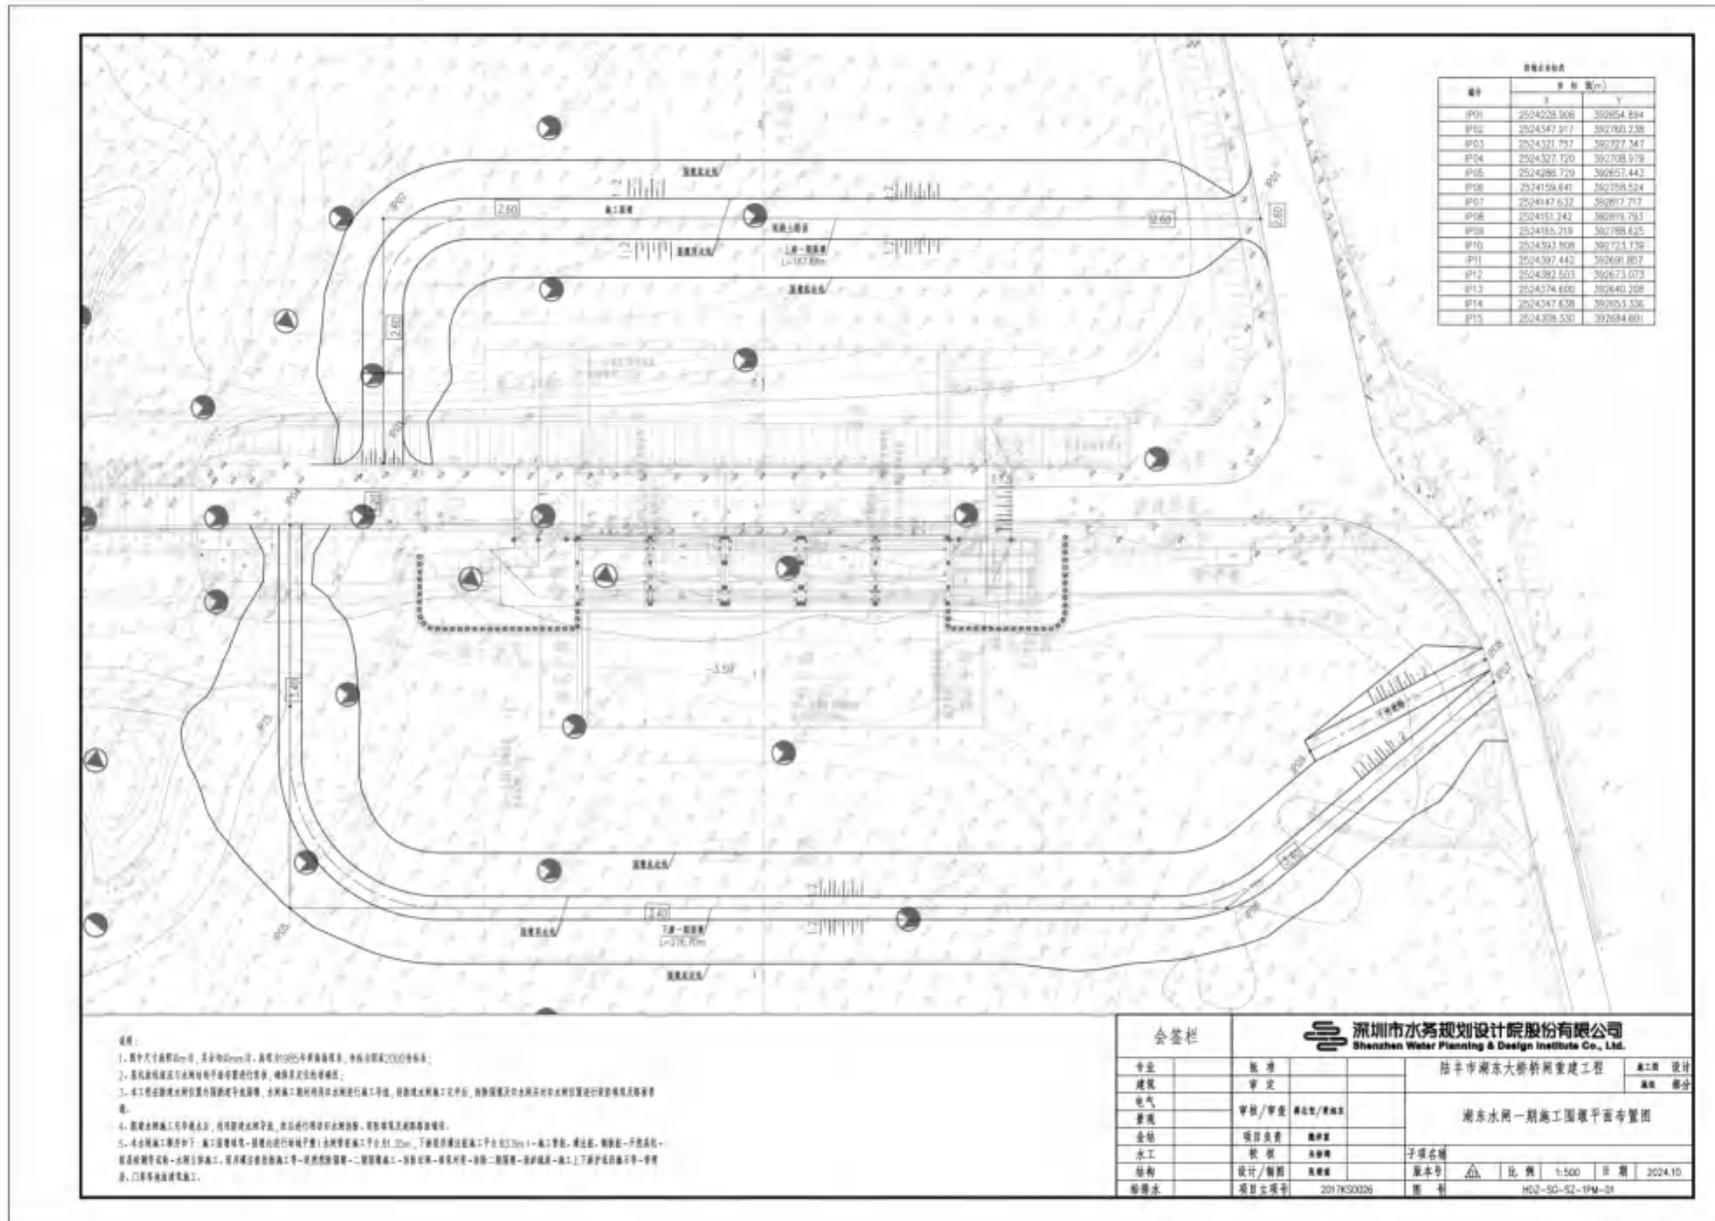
湖东桥闸一期施工围堰平面布置图
